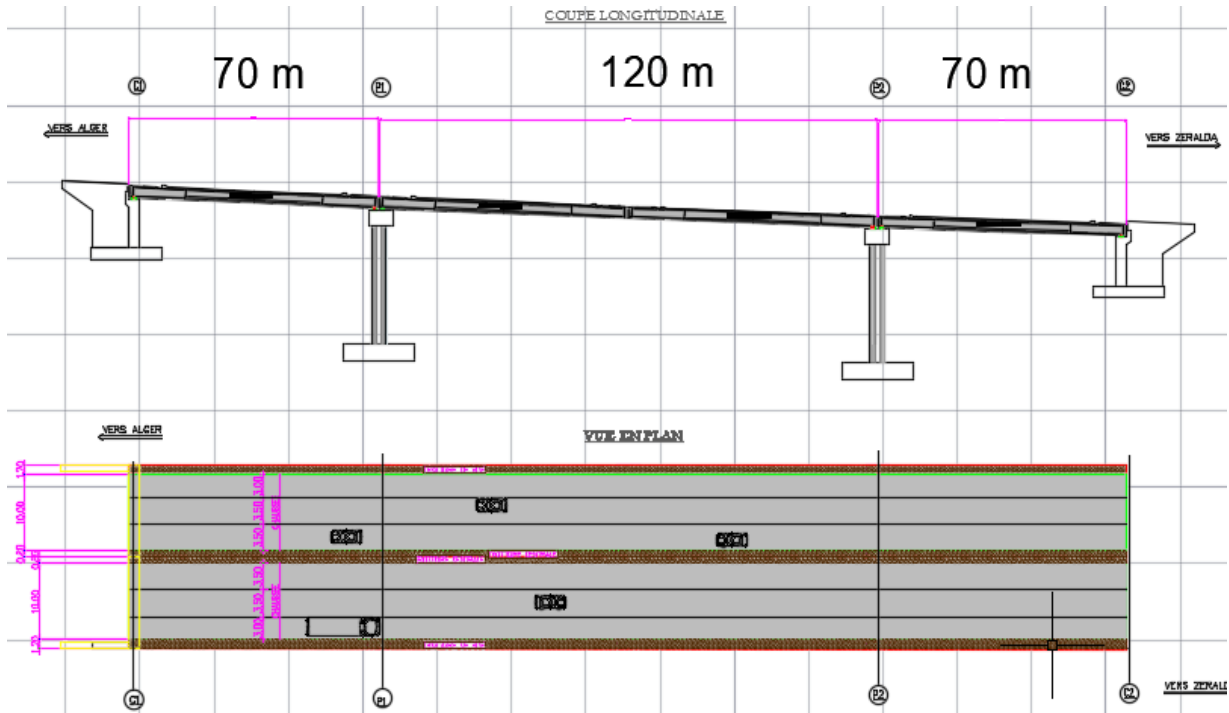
Coupe longitudinale et le tracé en plan de la 2<sup>ème</sup> variante
